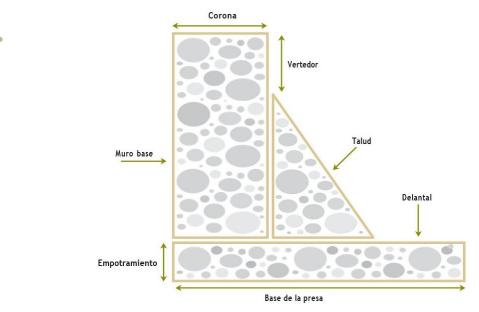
Partes que constituyen a una Represa de muro zampeado de piedra braza.
